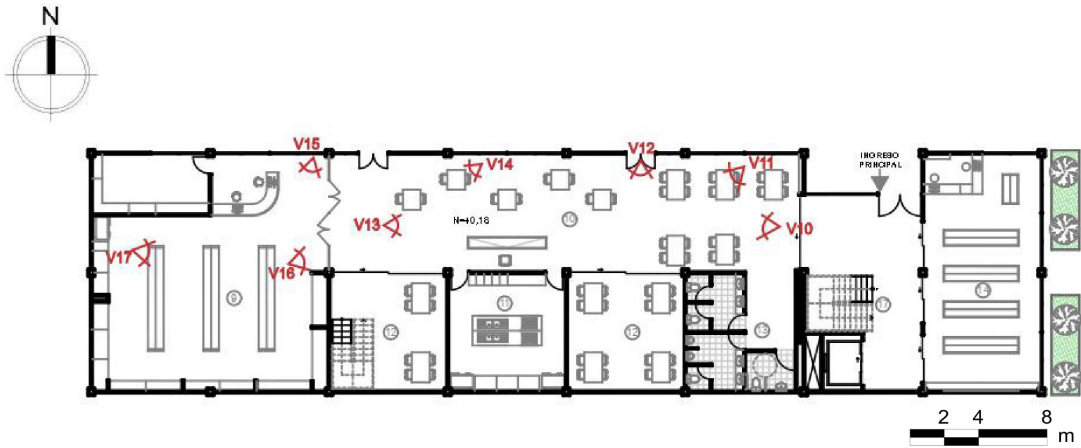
Plano que indica las vistas de la propuesta. Fuente y elaboración: Autores
